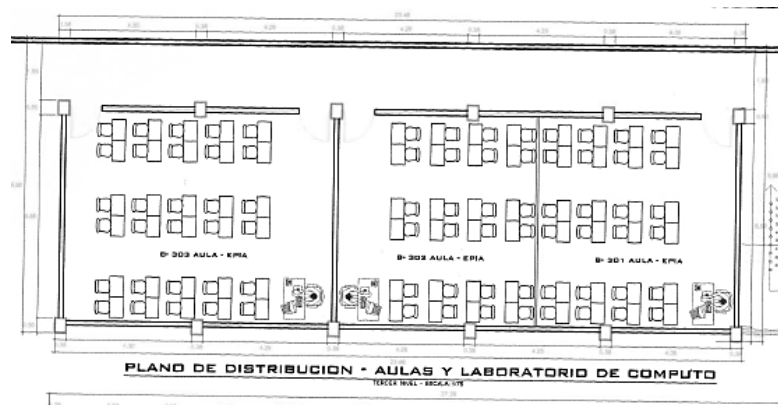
Plano de Distribución de la Segunda Sección de aulas y Laboratorios
